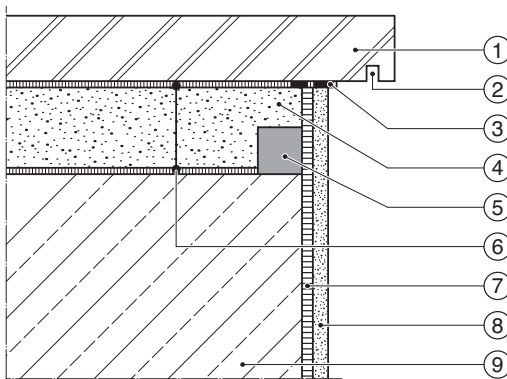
Detailschnitt der seitlichen Treppenbegrenzung
